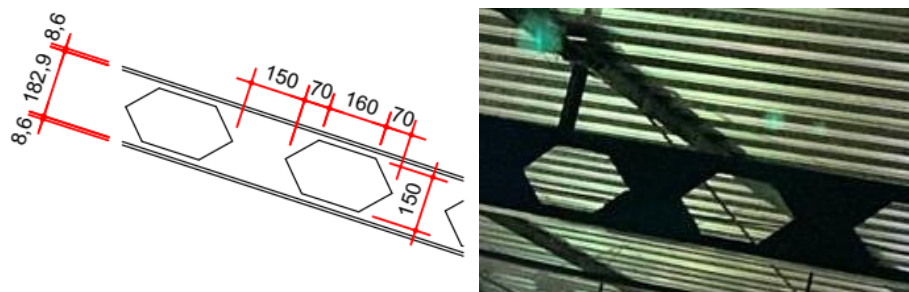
VISTA TÍPICA DA TESOURA (DIMENSÕES EM MM)
